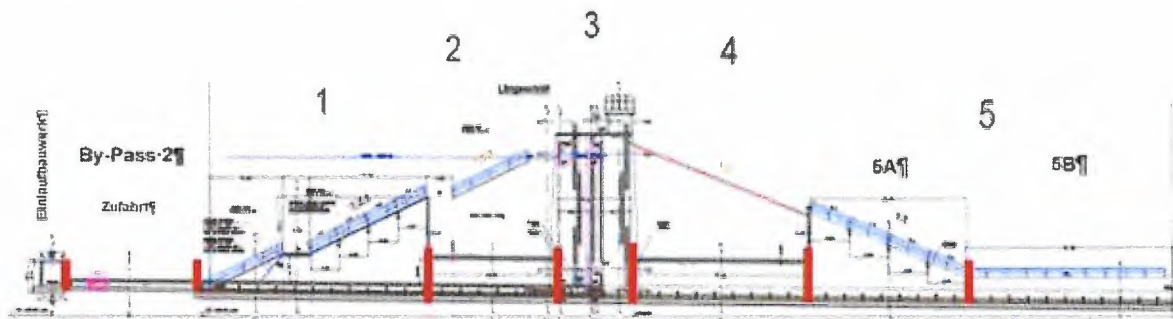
Grundablassbauwerk, Bewegungsfugen mit Dichtung (rote Linien); aus Bericht Vorbemessung
